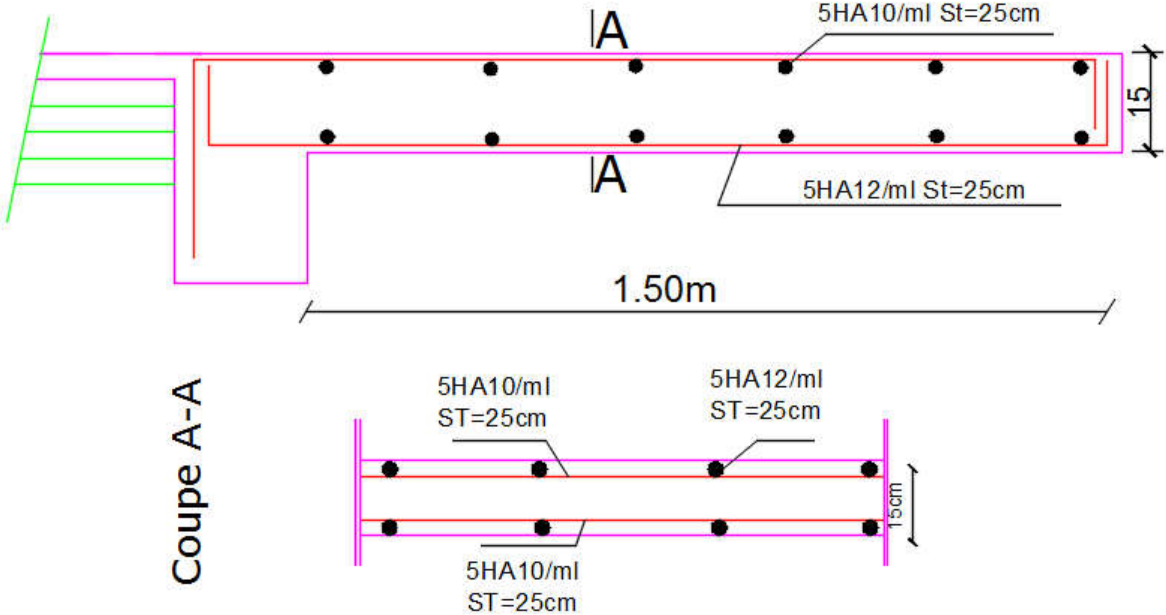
Schéma ferrailage de la dalle pleine balcon.
